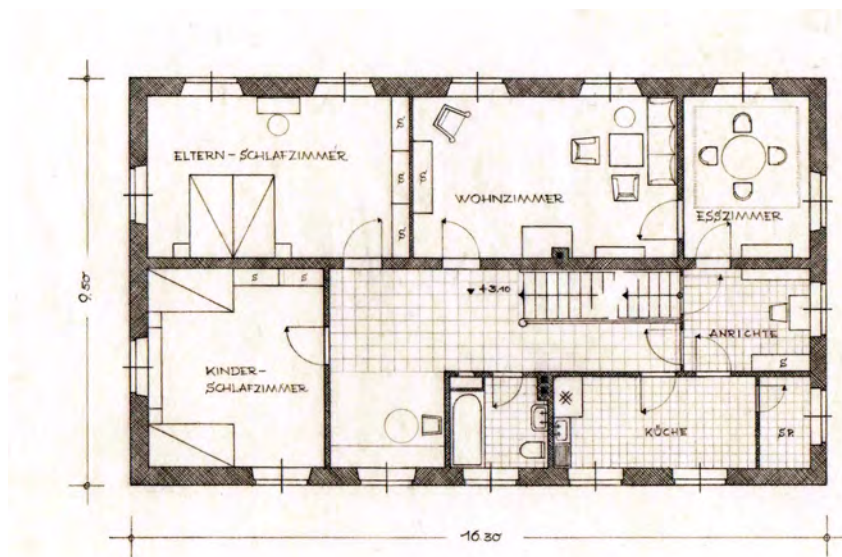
Zweiter Entwurf: „Apothek in Waldenbuch“, Grundriss Obergeschoss
